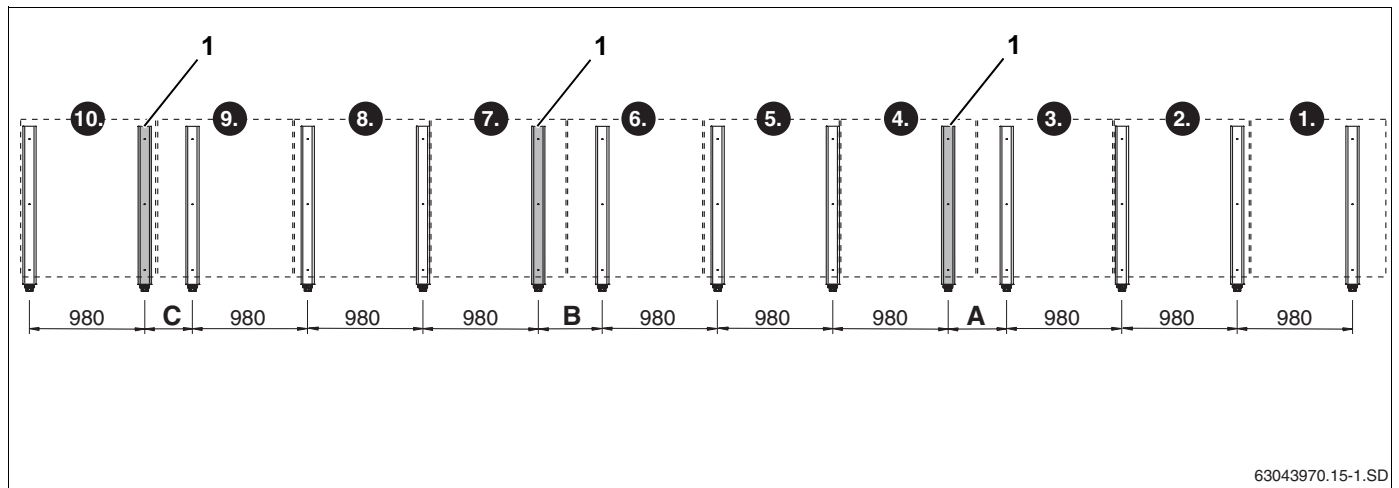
Grundmontering för upp till 10 lodräta solpaneler (mått i mm)
